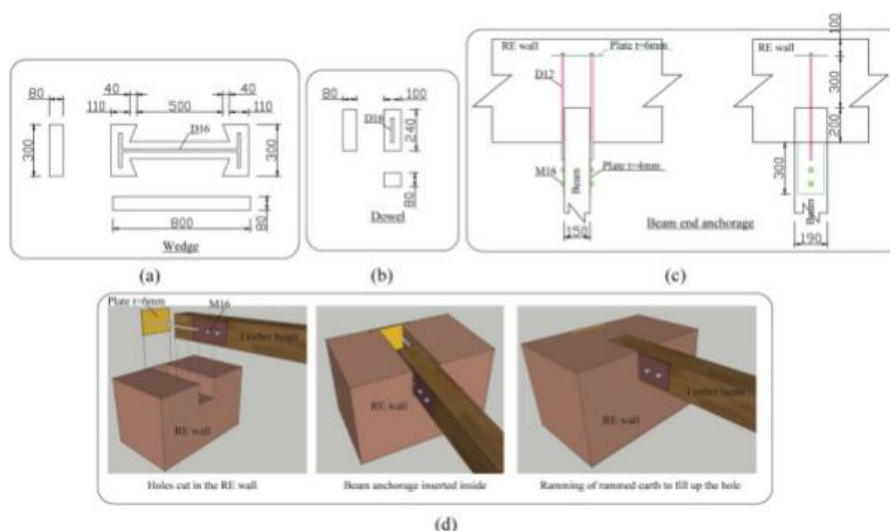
(a) Elementos de bloqueo de hormigón armado, (b) Bulones de hormigón armado, (c)Anclajes de extremo de viga, y (d) Procedimiento de anclaje de *Tuqiang* .
